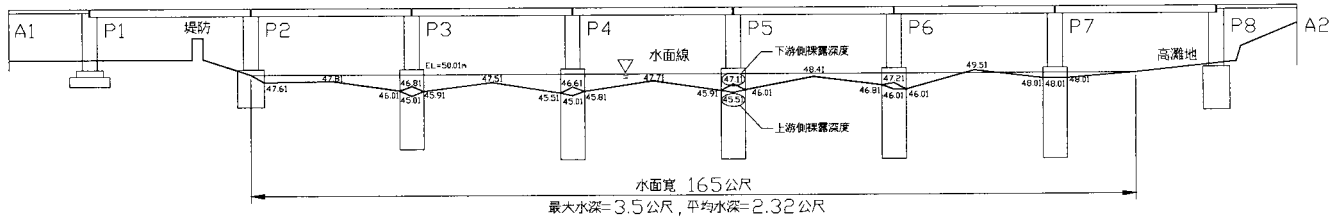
橋墩中心線河床高程斷面圖 (水平 : 垂直=1 : 1)
